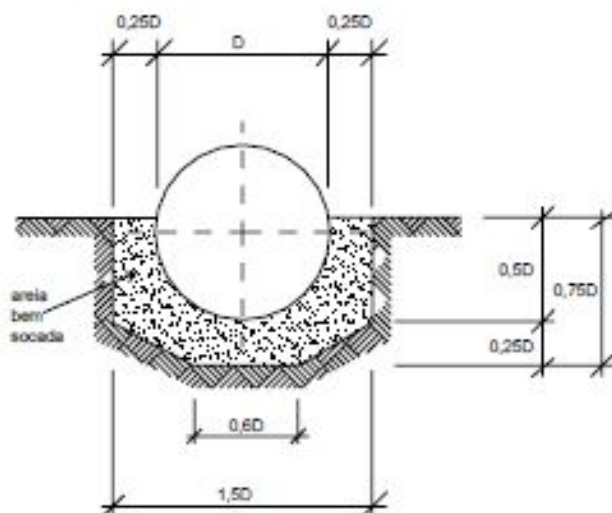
Perfil dos blocos de apoio para tubulação em aço de baixa pressão
